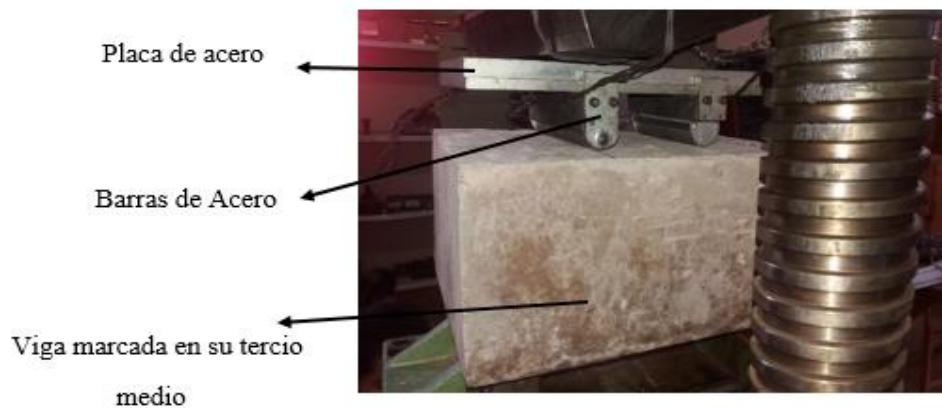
Apoyo de la probeta en la máquina de prueba.
